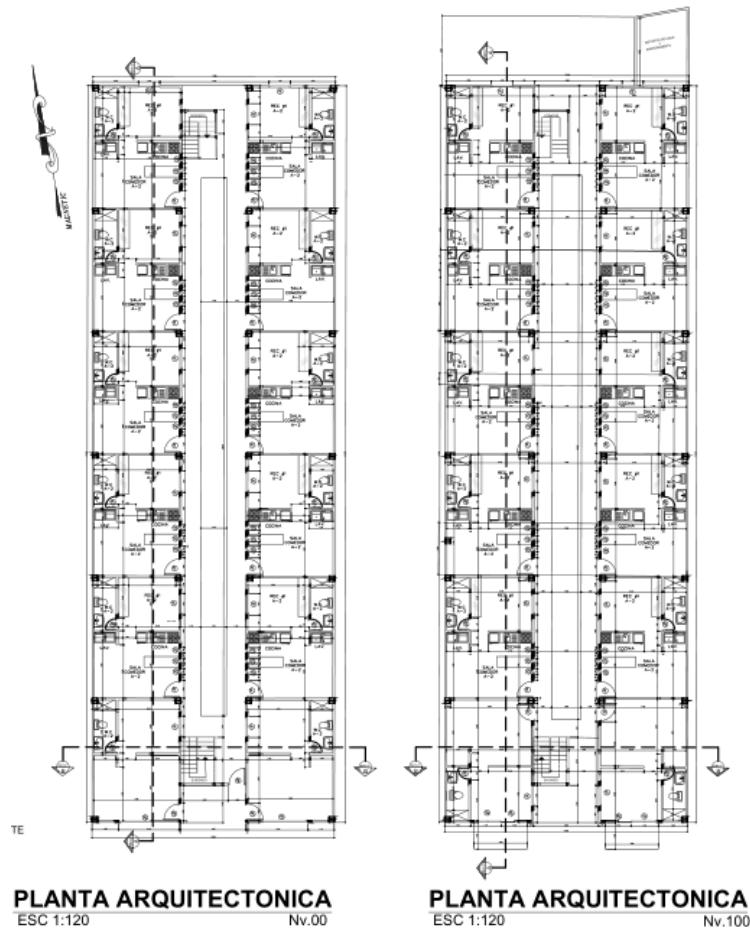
Planta arquitectónica nivel 000 y nivel 100
